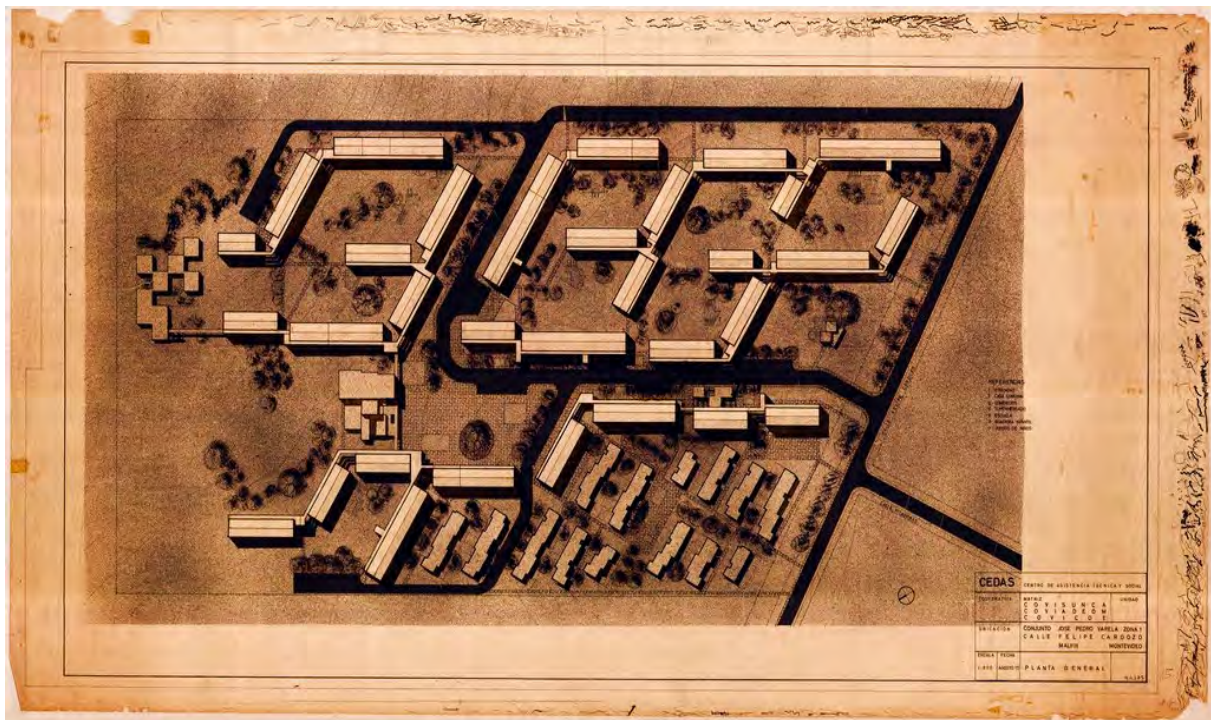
Cooperativa José Pedro Varela, Zona 1. Planta general del conjunto. PI.37412, Archivo IH. FADU.
